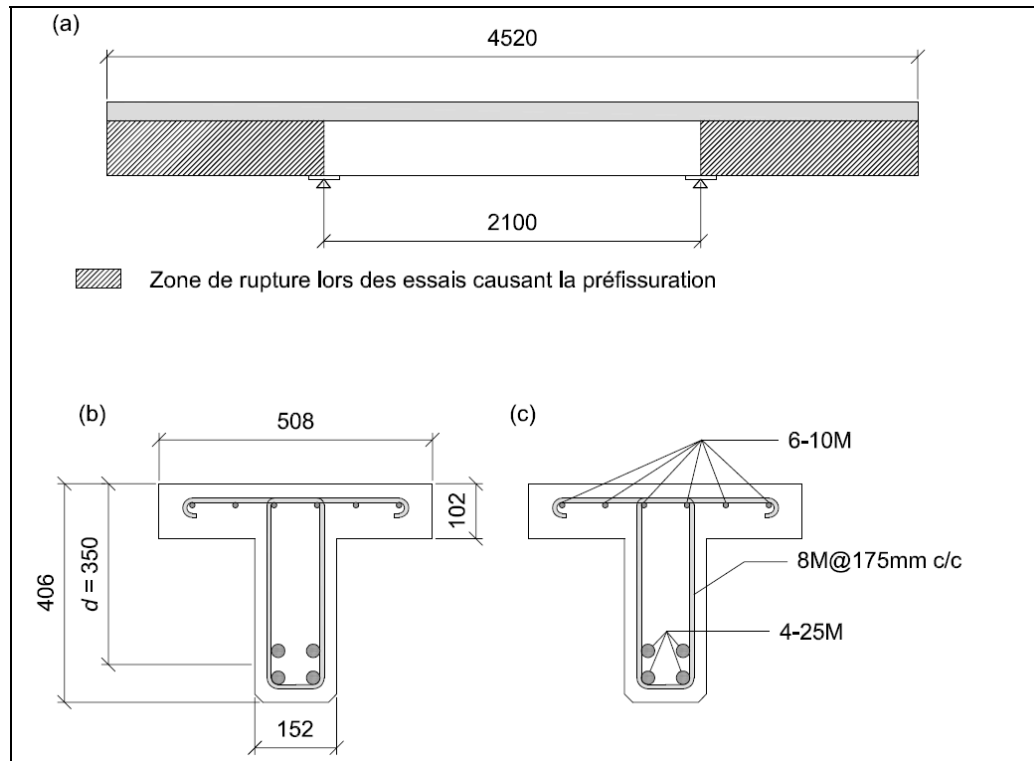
Caractéristiques des poutres : (a) longueur de la poutre; (b) dimension de la section; (c) ferrailage de la section
